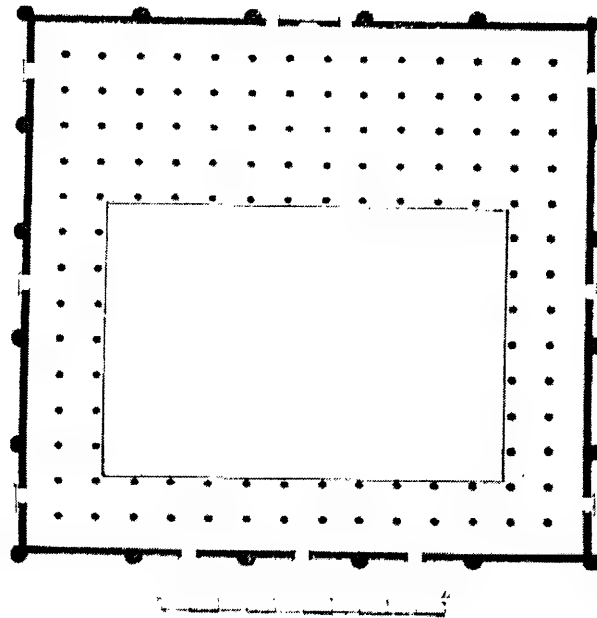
المسقط الأفقي للجامع الكبير بصنعاء (سنة ٦٢٧/٤٦ م).
